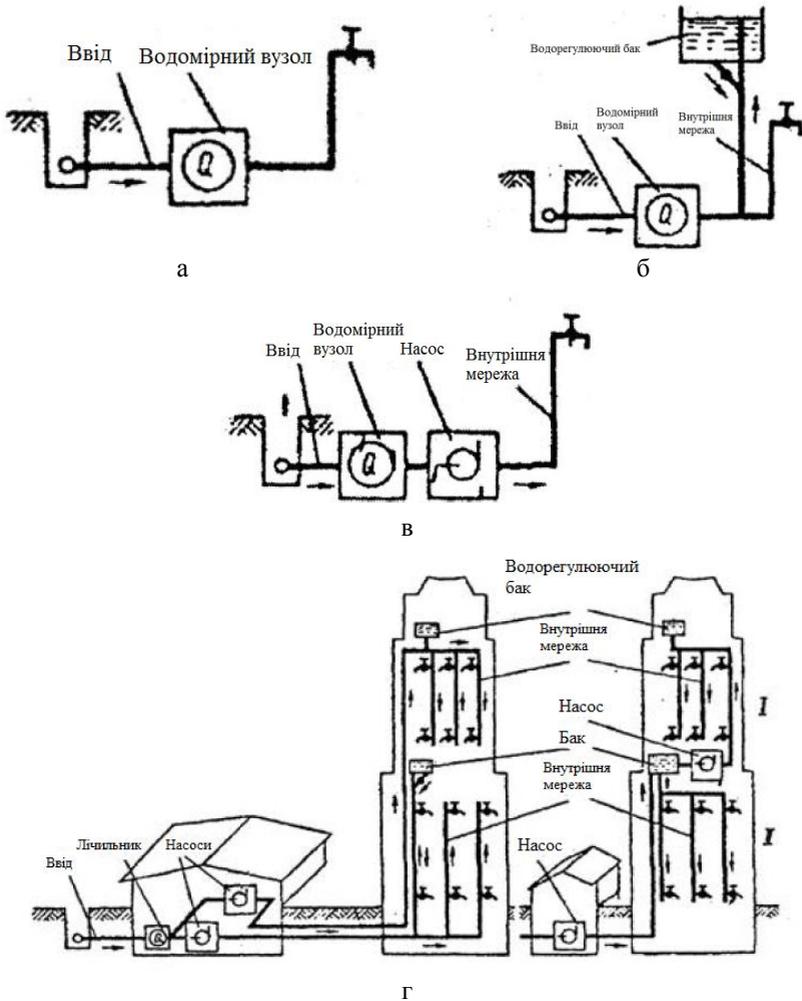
Схеми внутрішнього водопроводу:
